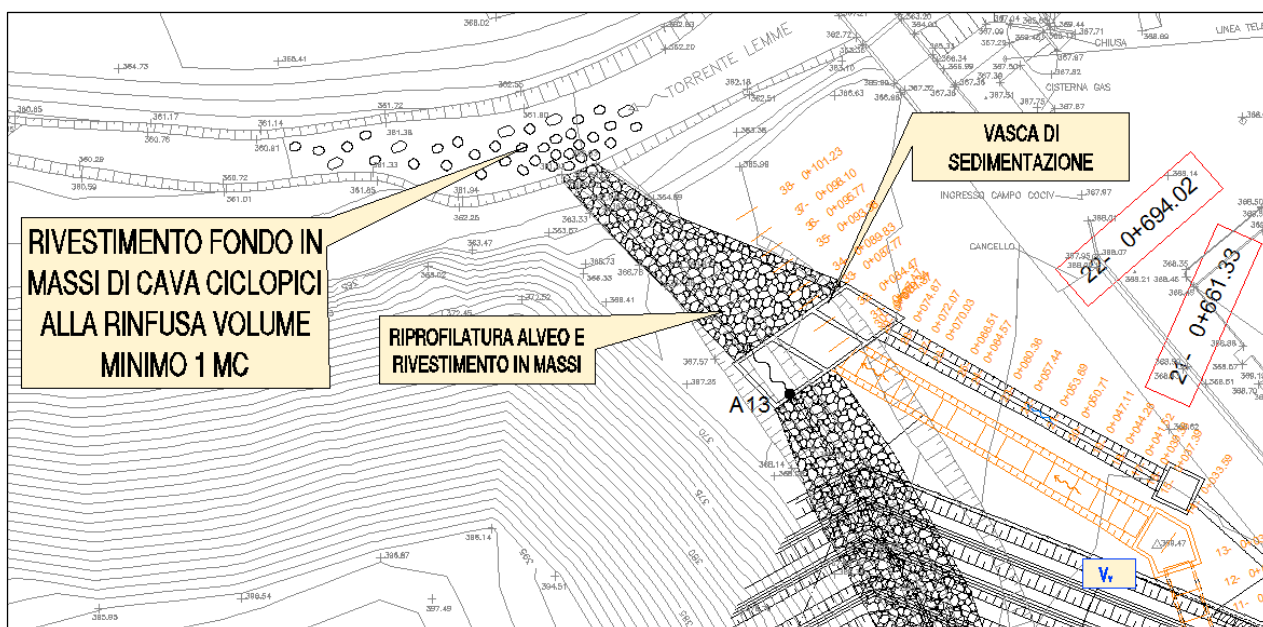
Scarico Nord. Rivestimento fondo t. Lemme con massi di cava ciclopici alla rinfusa. Planimetria
